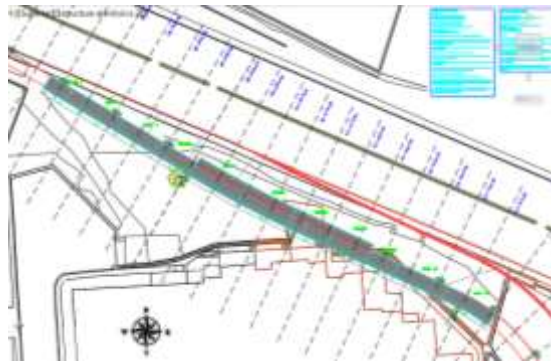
Planos muro anclado alto viento, fuente propia.
